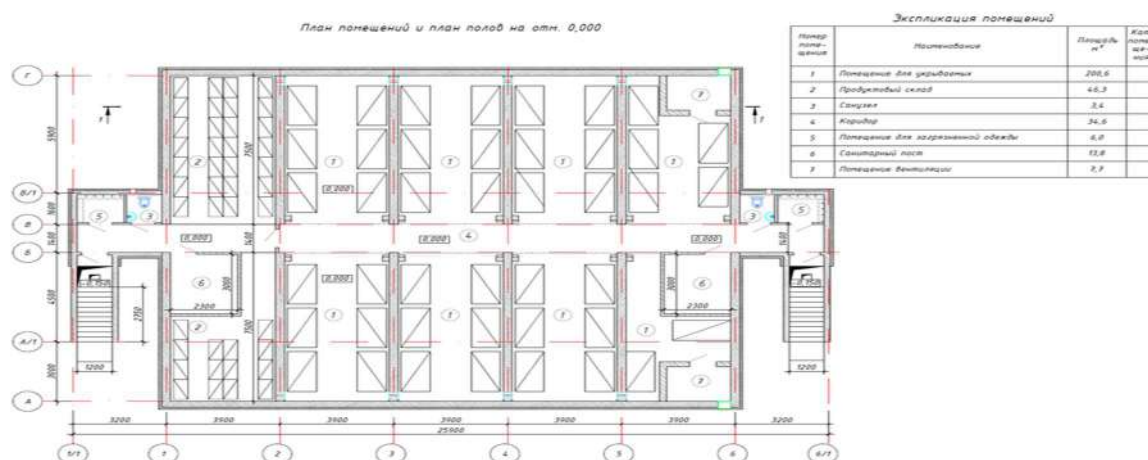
План помещений на отм.+0,000. Противорадиационное укрытие №2.
